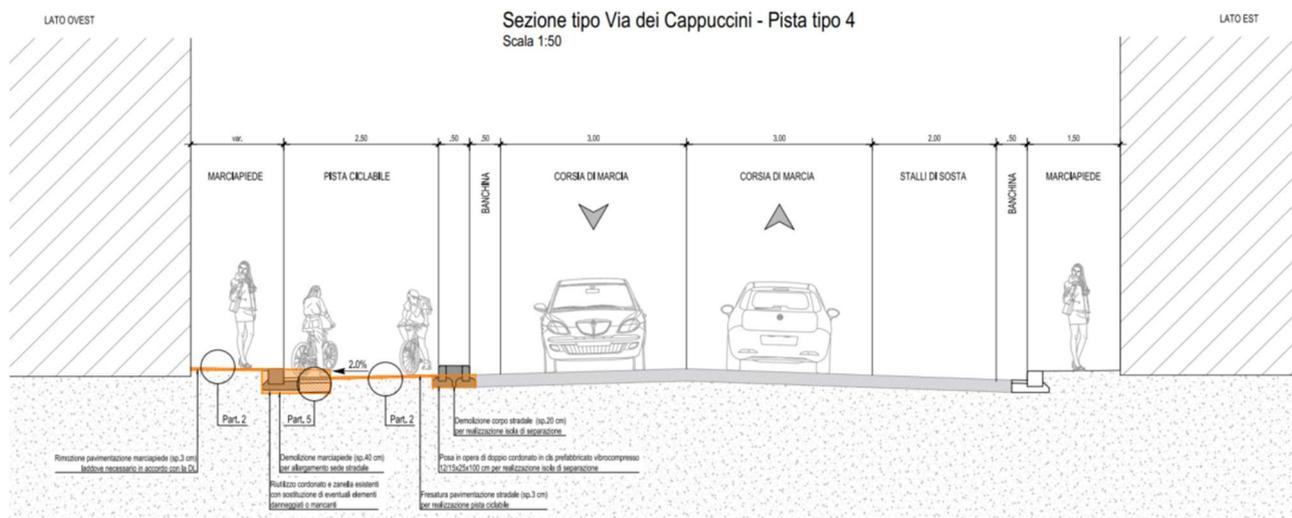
Sezione tipo Via dei Cappuccini – secondo tratto
